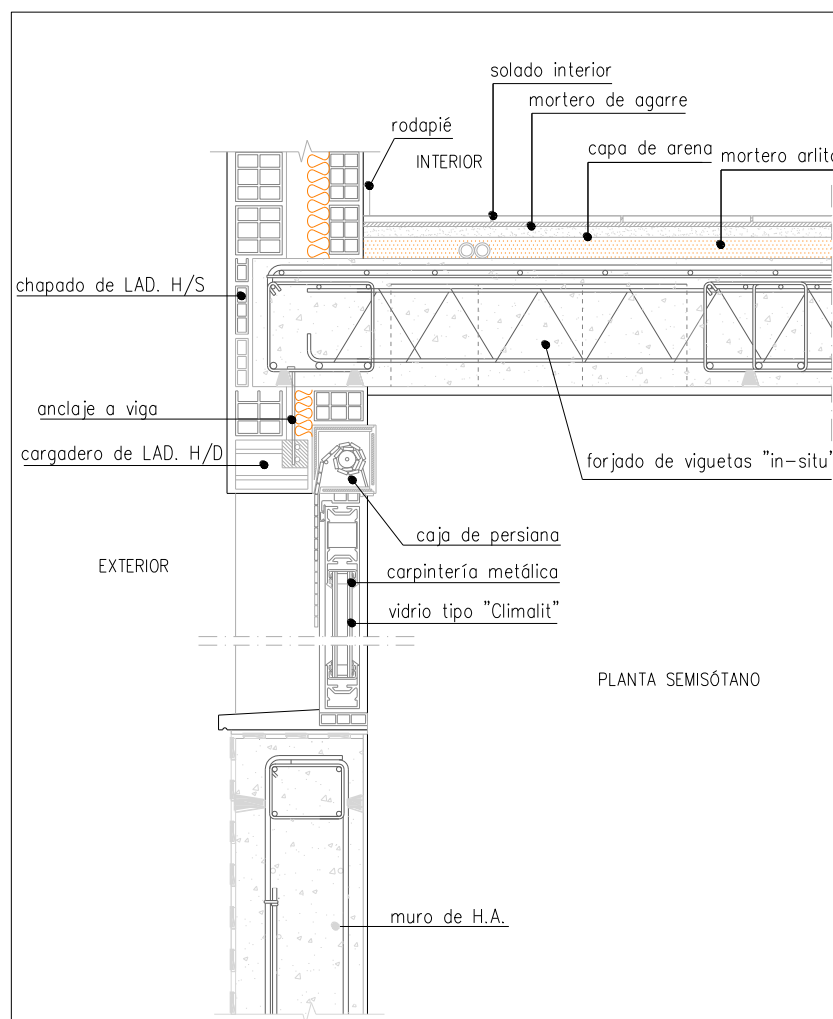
Detalle constructivo del suelo en contacto con planta semisótano
